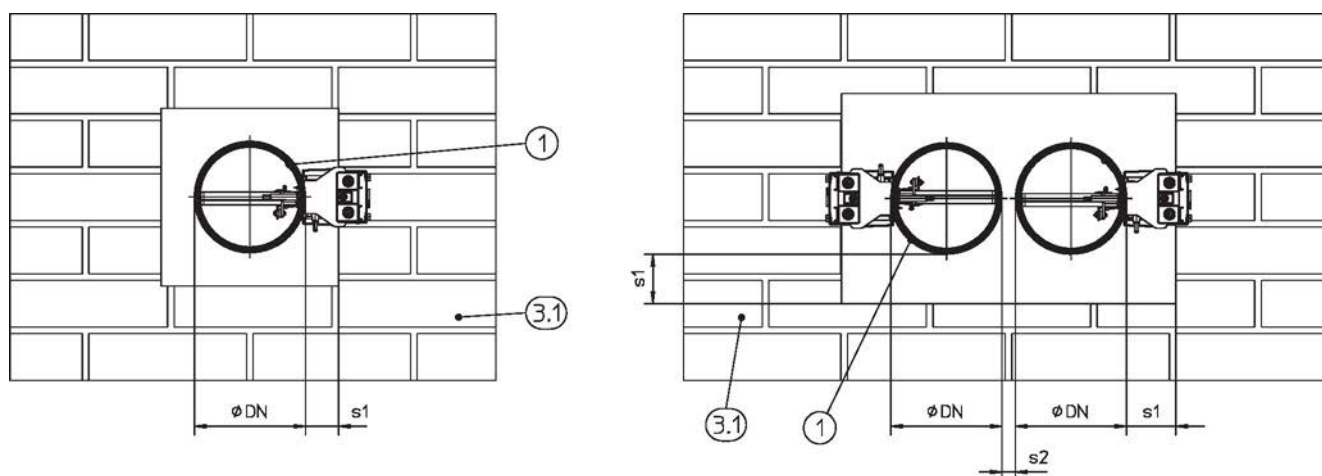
Pacchetto di fornitura e installazione del kit di installazione GL2 per installazione a secco senza malta
